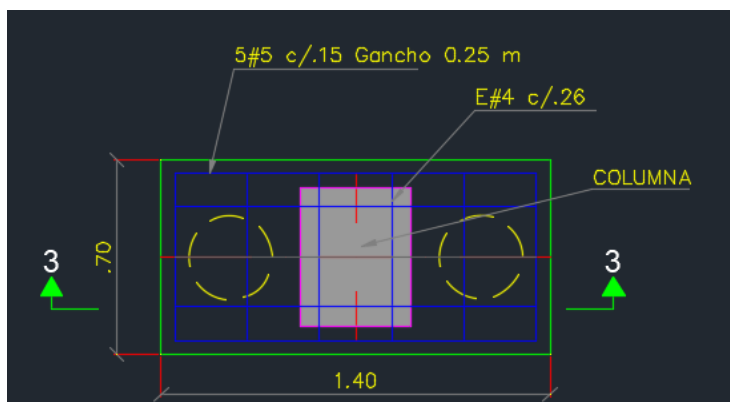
Ilustración de refuerzo planta cabezal tipo 2 (CB-2)
